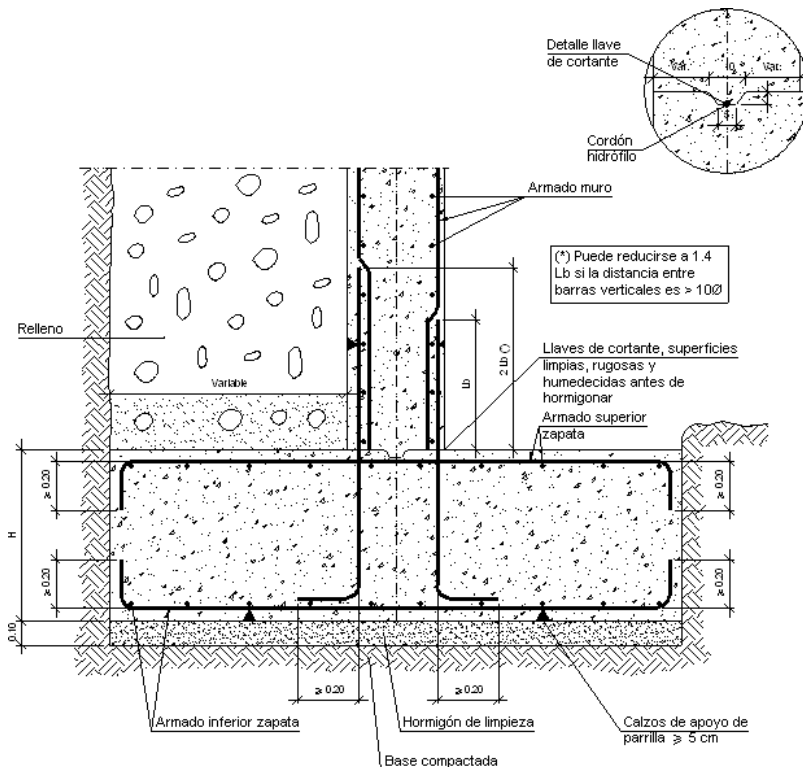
Zapata aislada centrada. Fuente: CYPE, Biblioteca de detalles constructivos, Regalado et al., (2004).
